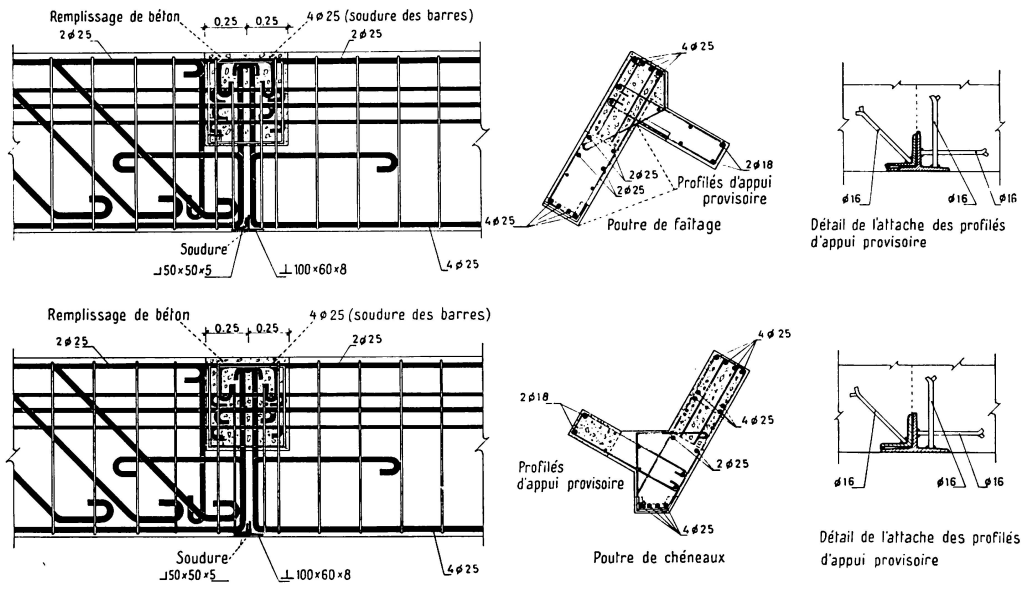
Assemblage des éléments d'une poutre préfabriquée *Atelier de Metalurgica Santa Ana (Linares)*.
